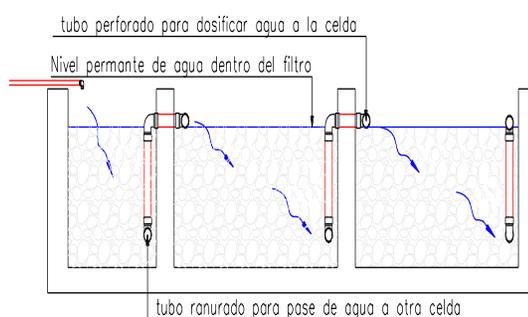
Vista de perfil (corte B-B') del sistema de filtración
